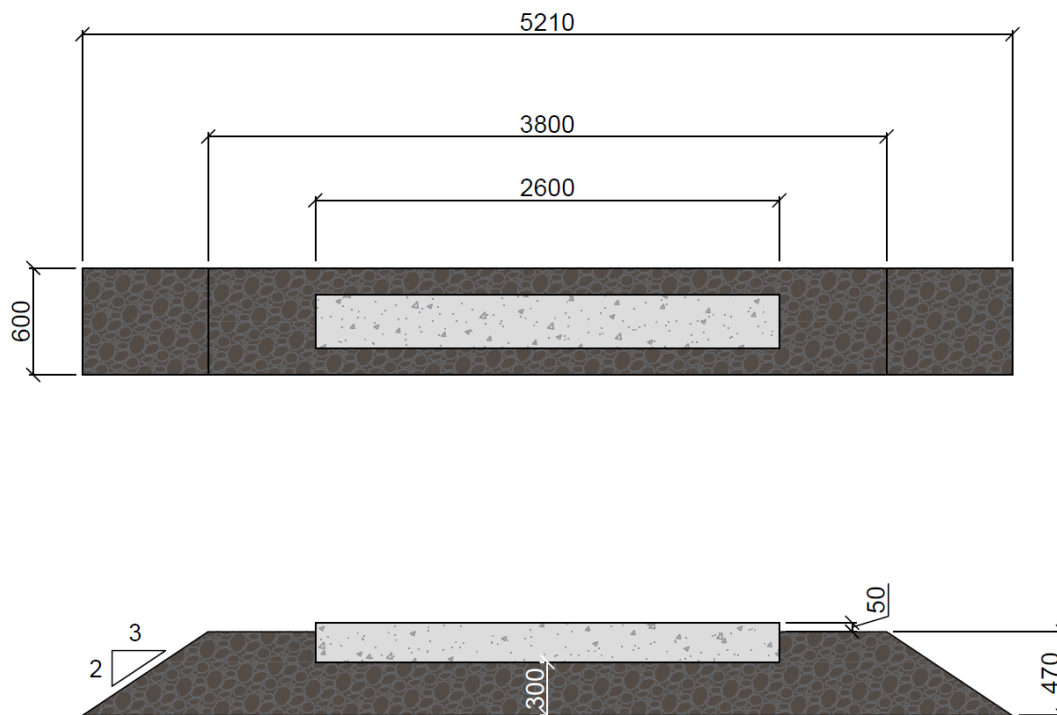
Descripción esquemática de una Unidad Básica del modelo. Vista en planta (superior) y vista en alzado (inferior). Dimensiones en mm. (Elaboración propia)
